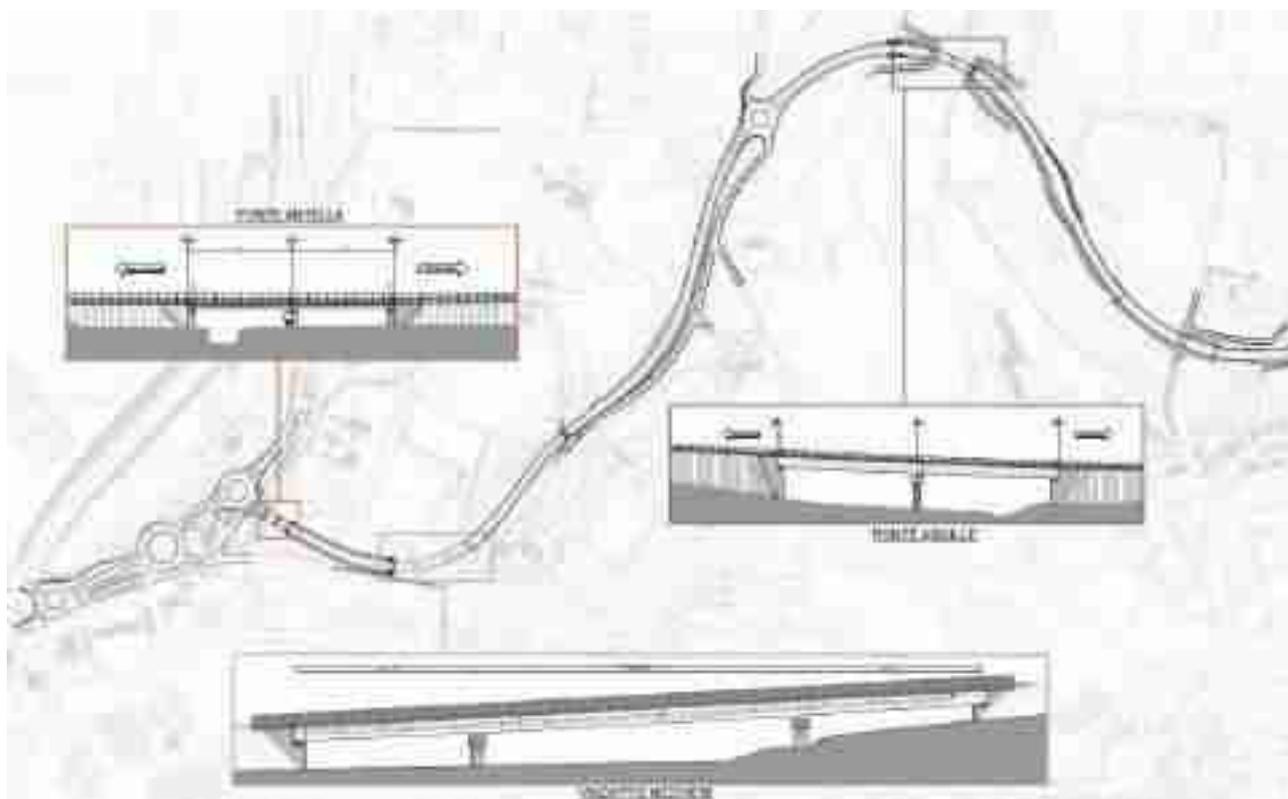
Planimetria interventi sulla SR222 "Chiantigiana"
